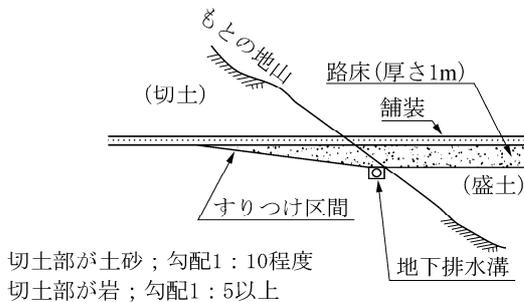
盛土基礎地盤上の段切り及び切土・盛土の接続部（土砂地盤の例）
